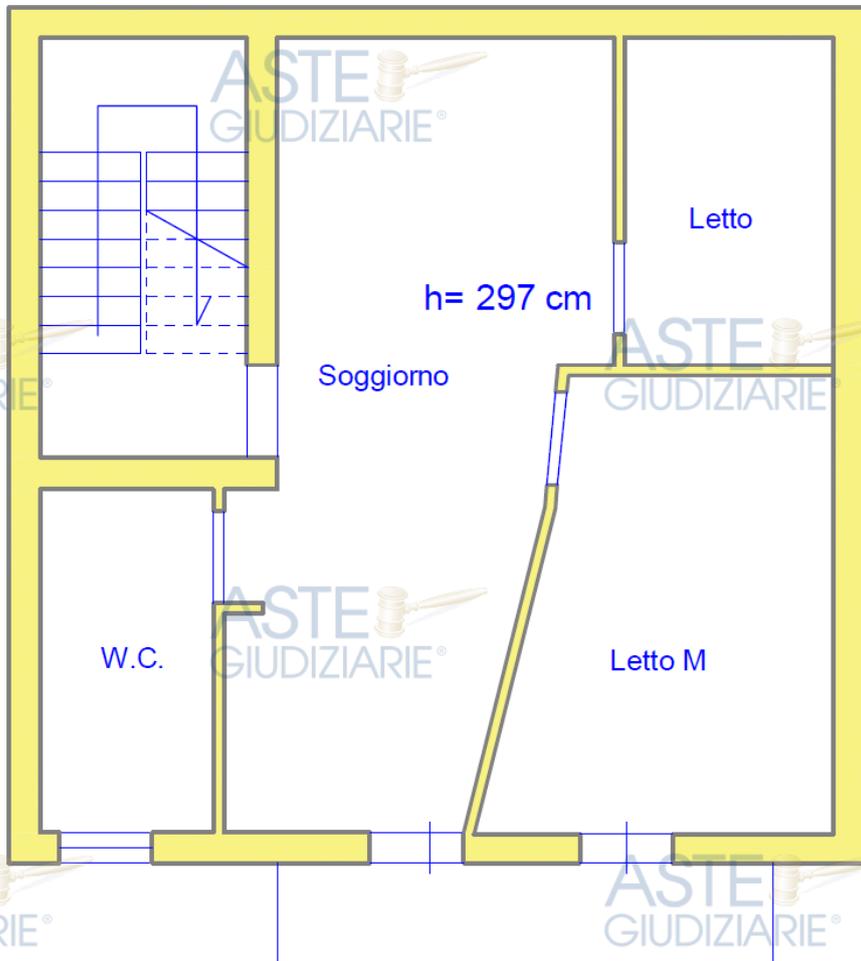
Pianta piano secondo (disegno fuori scala)
